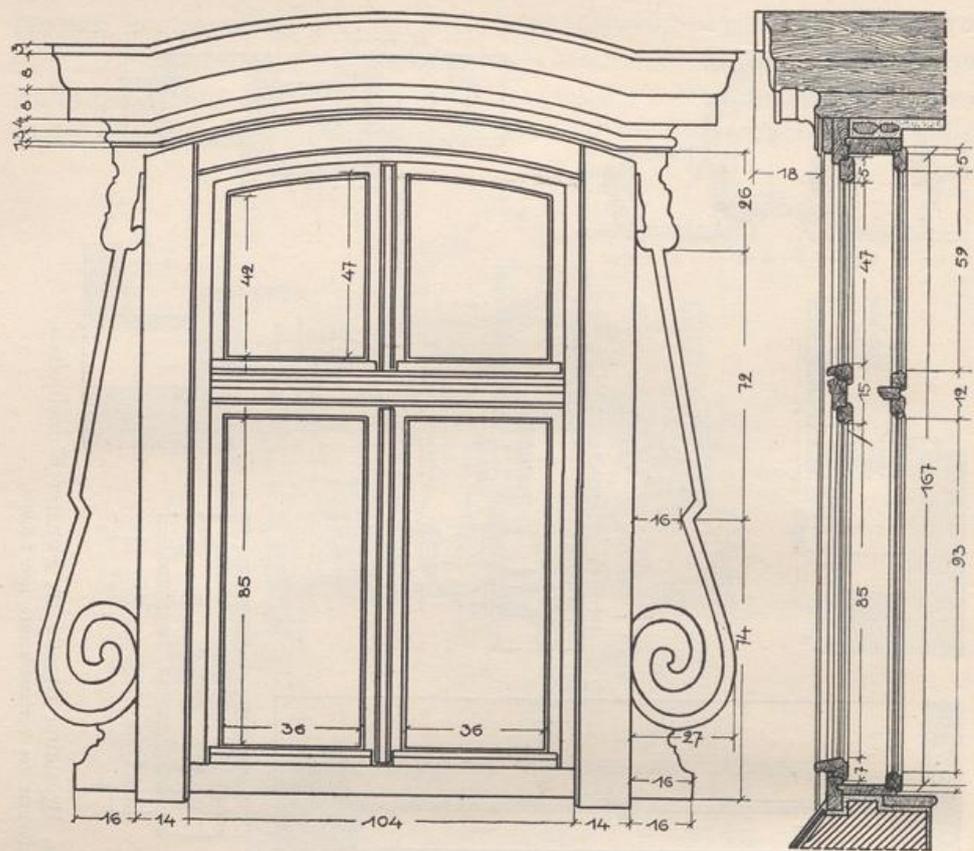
Posen, Breslauer Straße 16, Dachgaupe.
